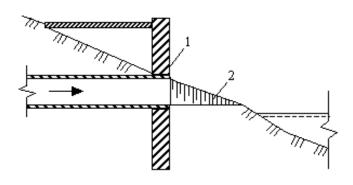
Незатопленный береговой выпуск 1 – бетонная стенка; 2 – лоток
